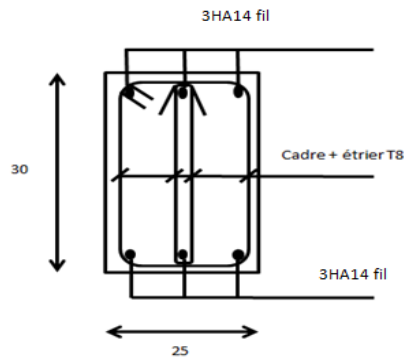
Ferrailage sur appuis d'une poutre secondaire solidaire des voiles.
